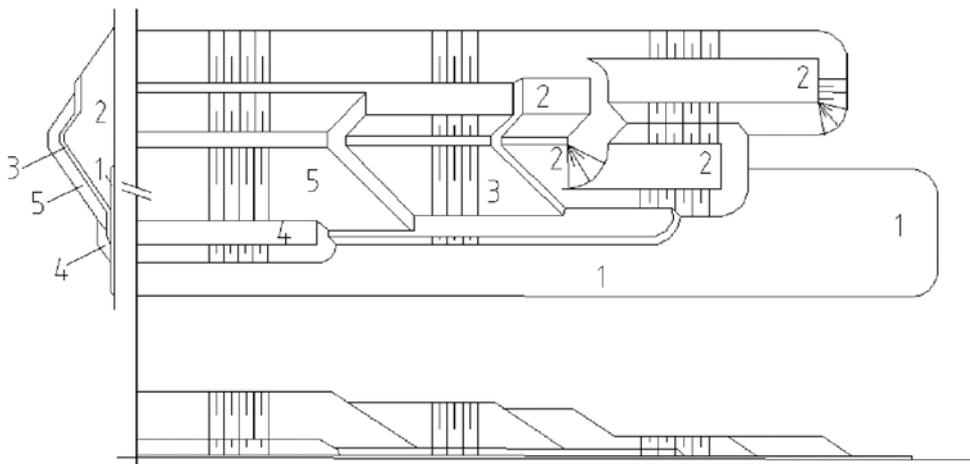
Vue en plan, de côté et coupe transversale d'un chantier de construction par voie nautique d'une digue ; le matériel n'est pas montré.
